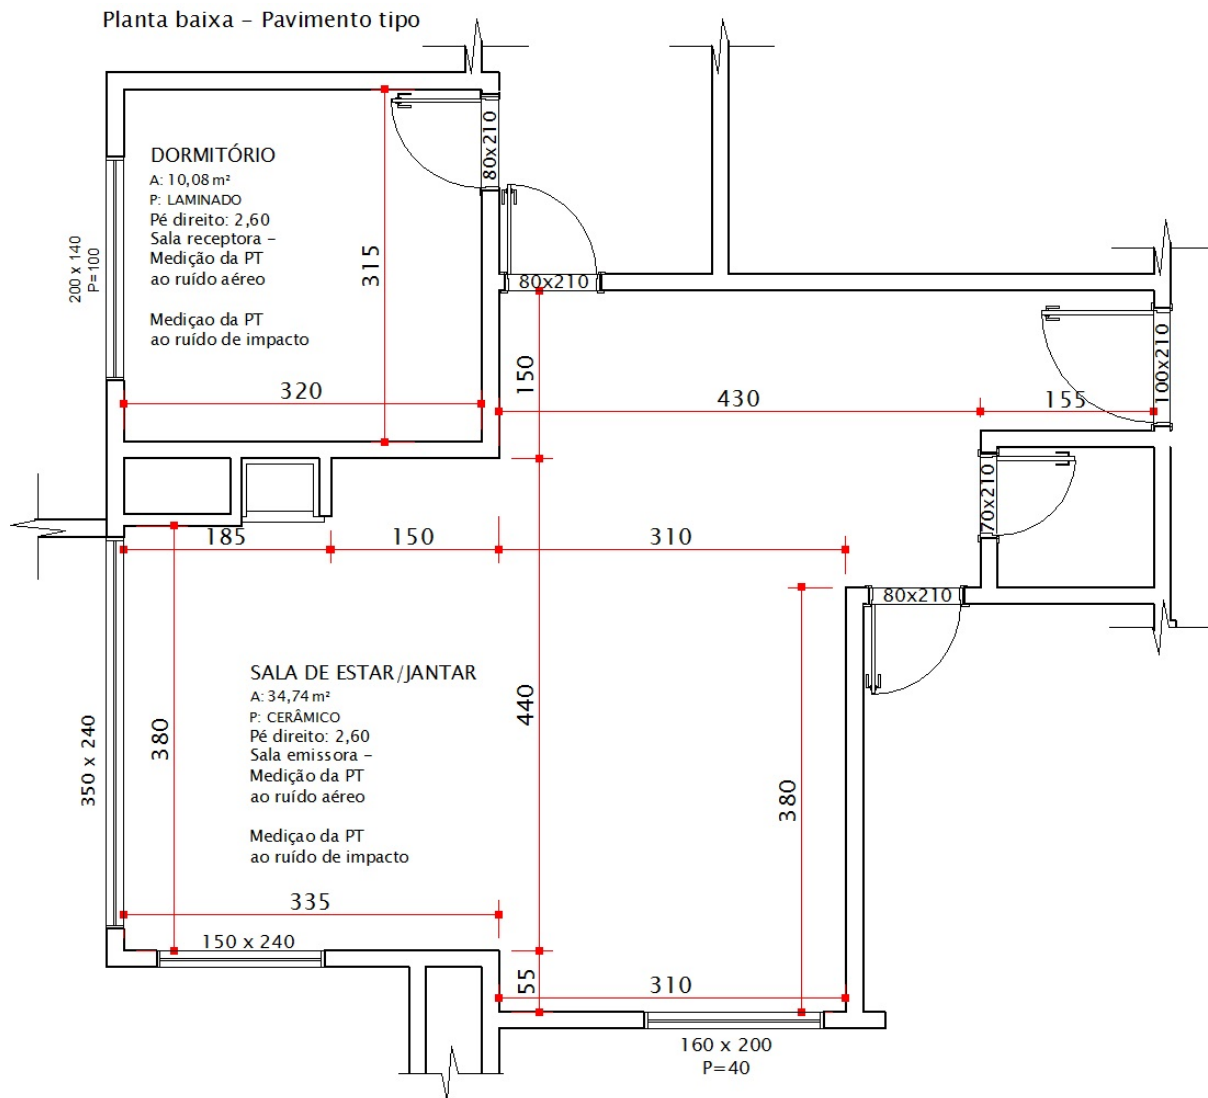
Planta baixa - pavimento tipo - 14-R8-N-BCO-PC-PL
